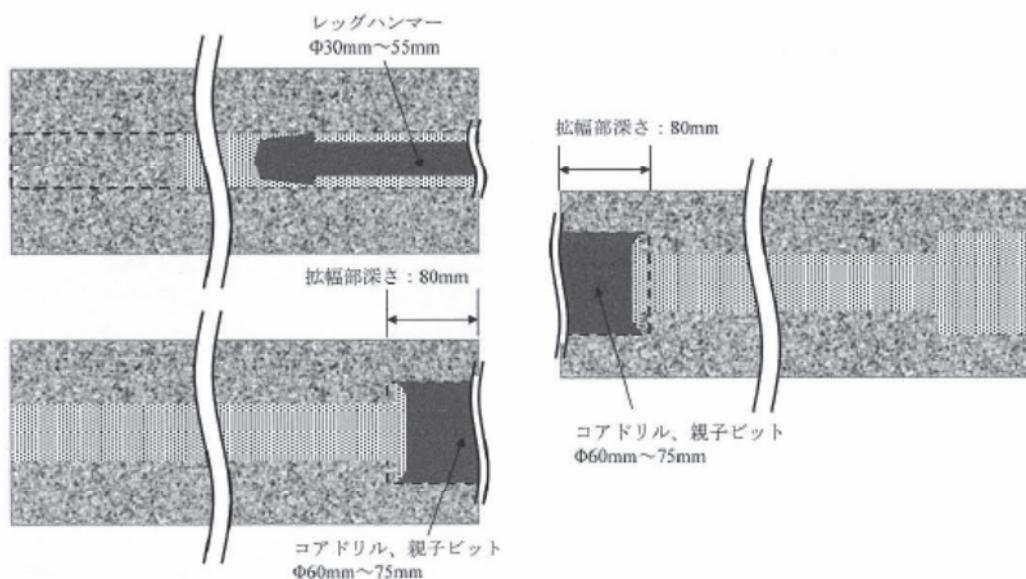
先充てん後挿入法（上向き）の施工手順（その1）
